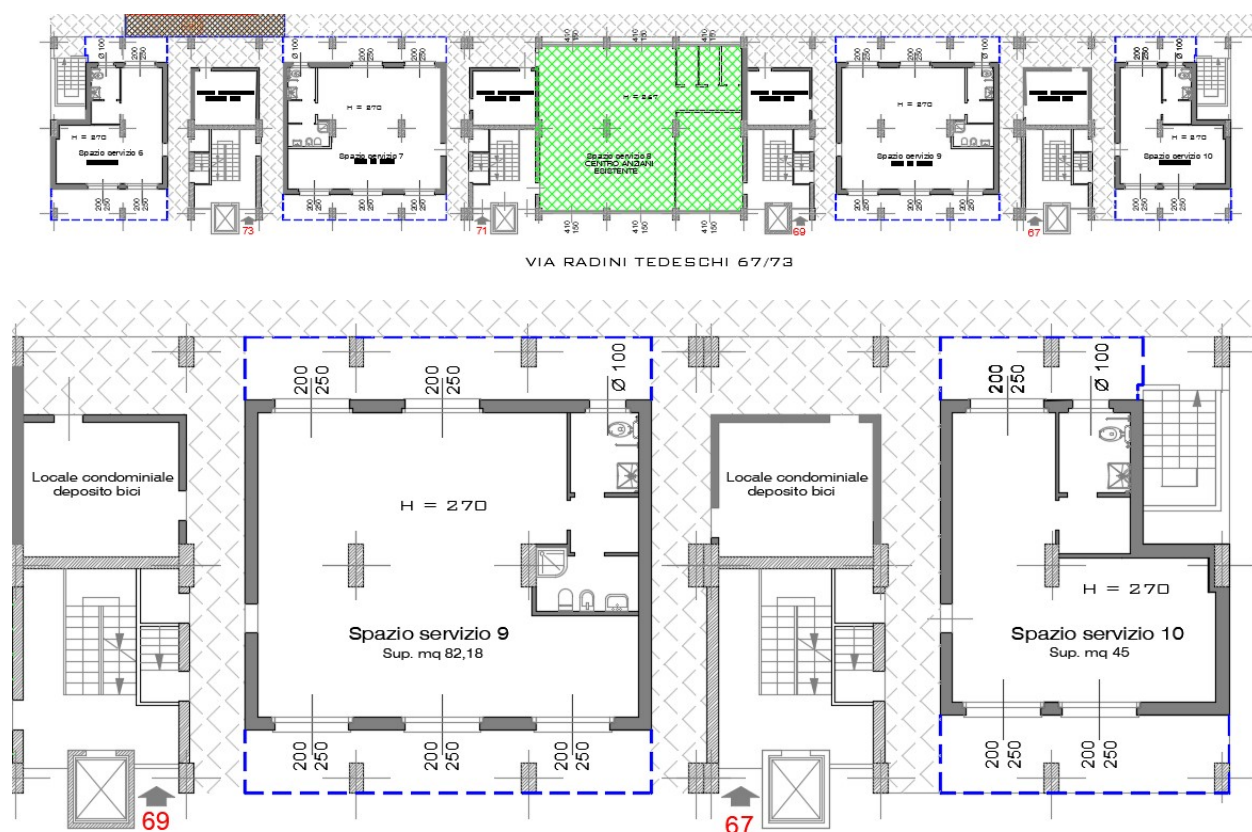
Stralcio piante pilotis di progetto - civico 67/73
